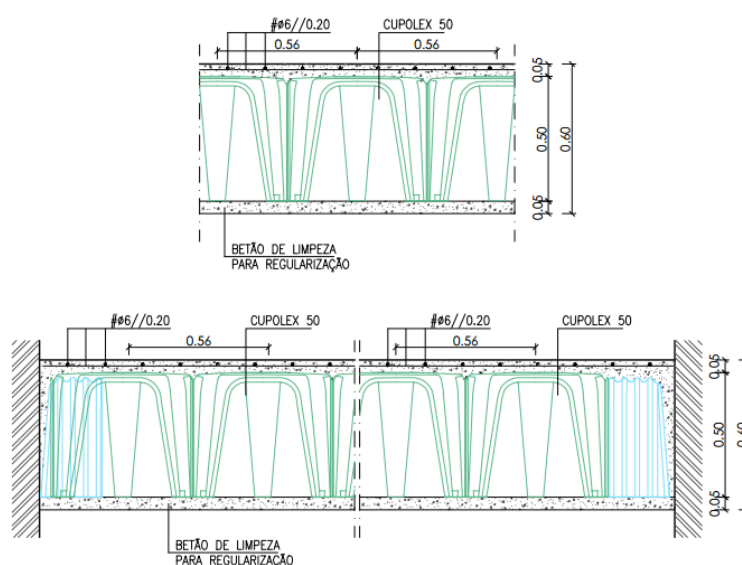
Corte do Sistema Cupolex da Ferca- Características do Pavimento [Fonte: Ref. Desenho PE-FC-19; Autor: Atelier NiNi Andrade Silva]
